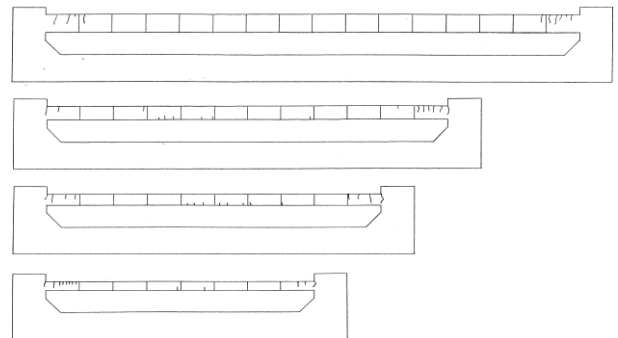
試験体ひび割れ状況 (0.1mm 以上)
